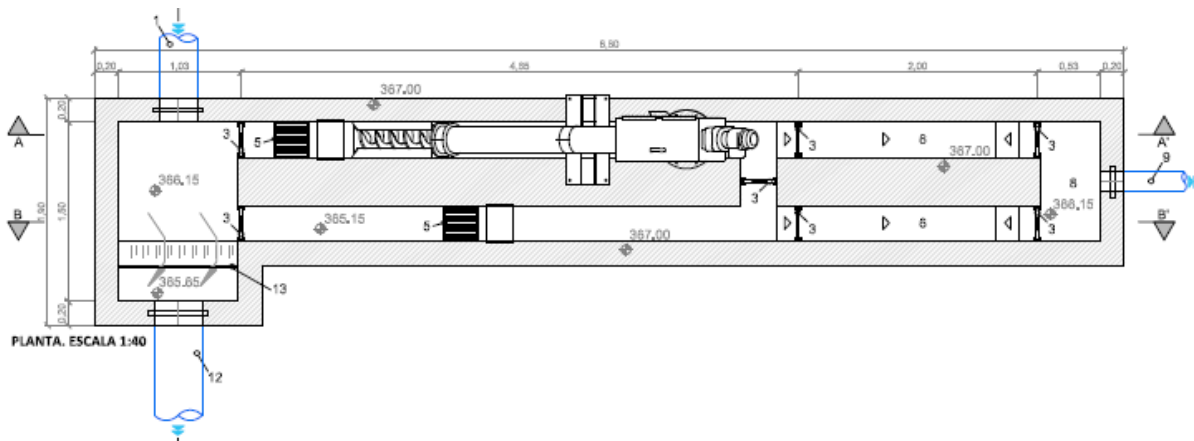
PLANTA DEL PRETRATAMIENTO PROPUESTO
